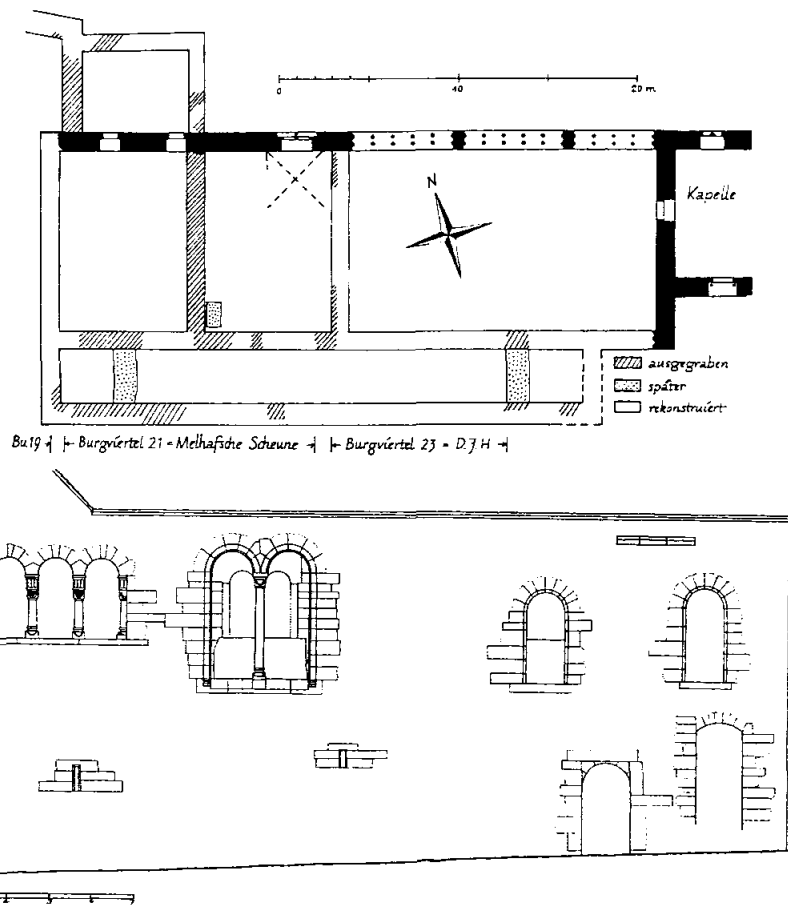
, 29: Münzenberg, Burg, Palas, Grundriß Untergeschoß und 1. Obergeschoß, Längsschnitt, Rekonstruktion (G. Binding).
